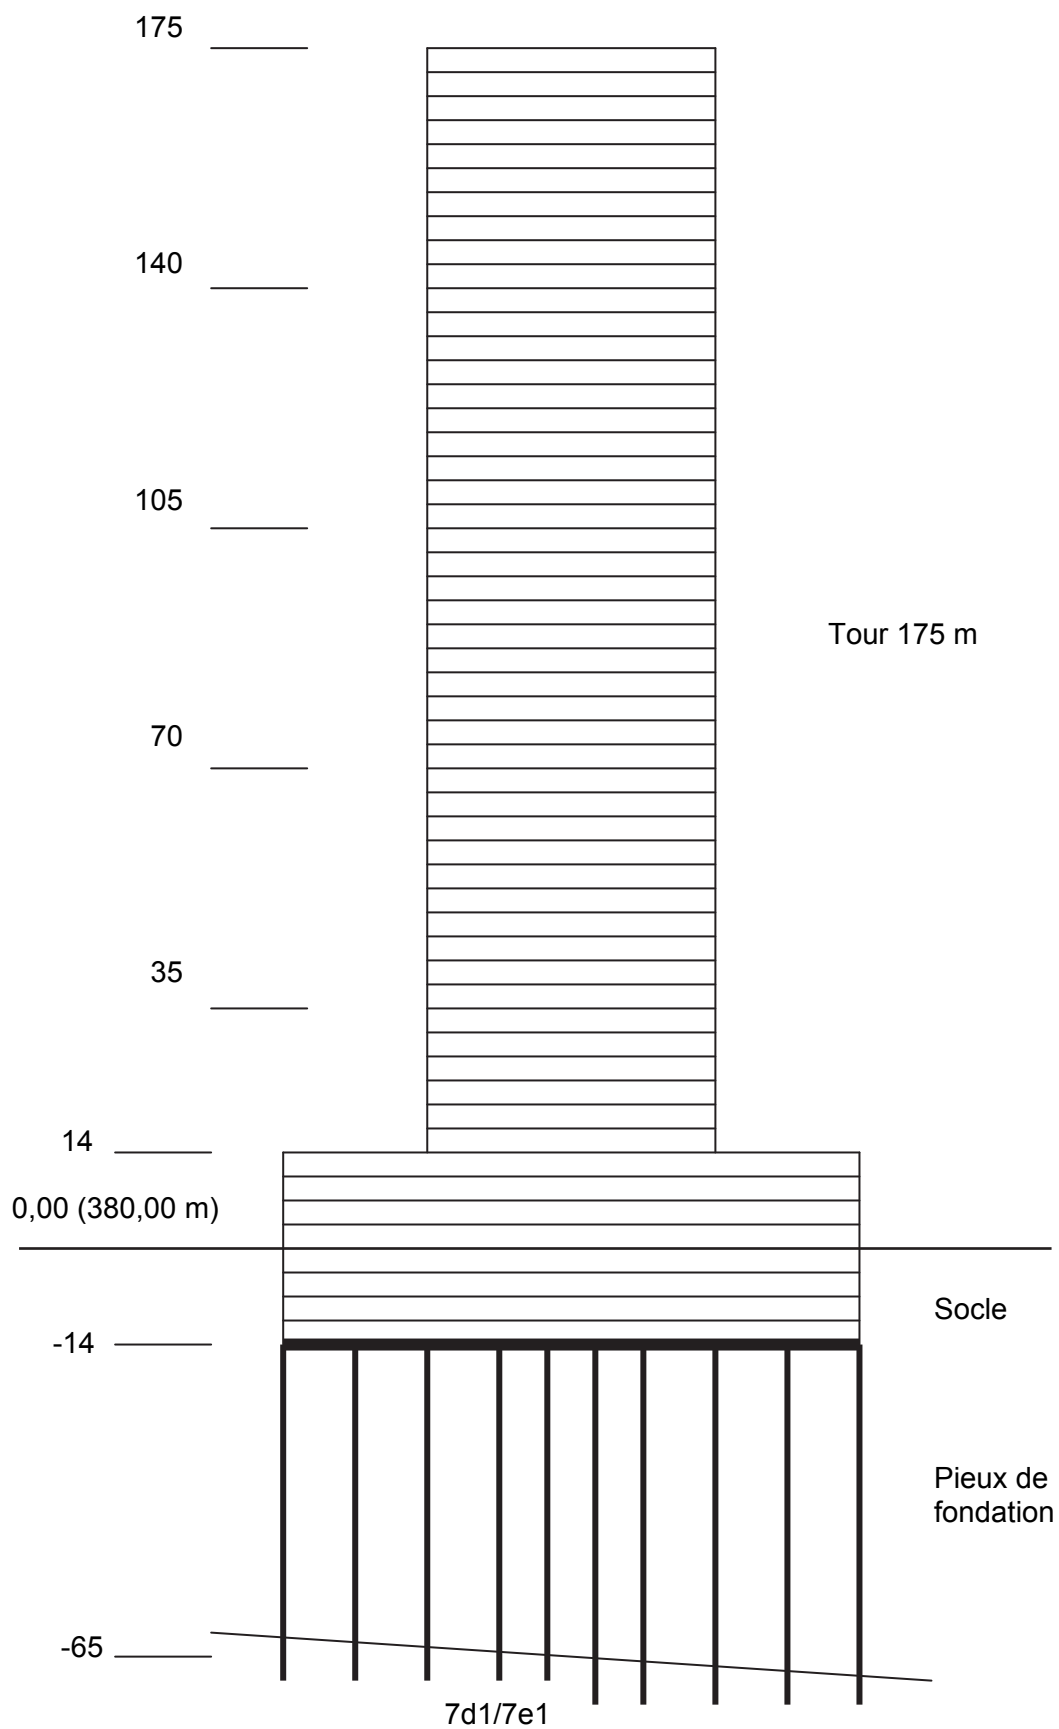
PAV Secteur Etoile – Esquisse structurale d’un bâtiment tour de 175 m sur barrettes de fondation.
